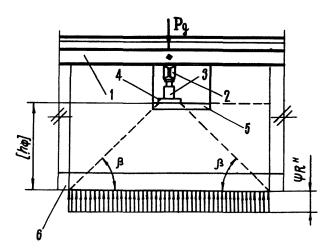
У.2. Схема нагрузок на ленточный фундамент в предельном состоянии при выправлении здакия способом поддомкрачивания:
